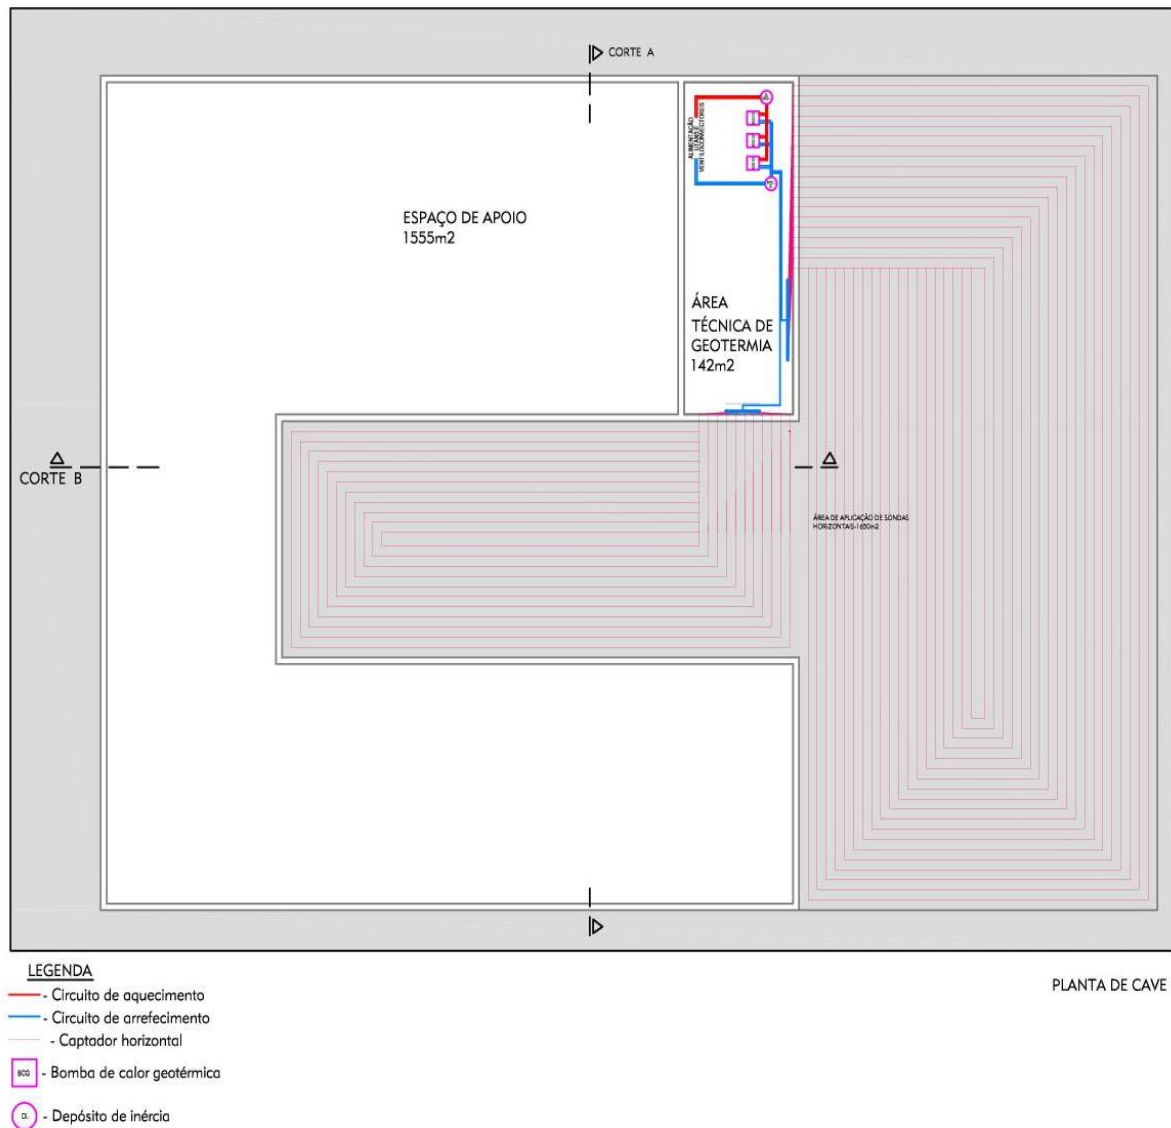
Alternativa caso se pretenda instalar sondas horizontais
